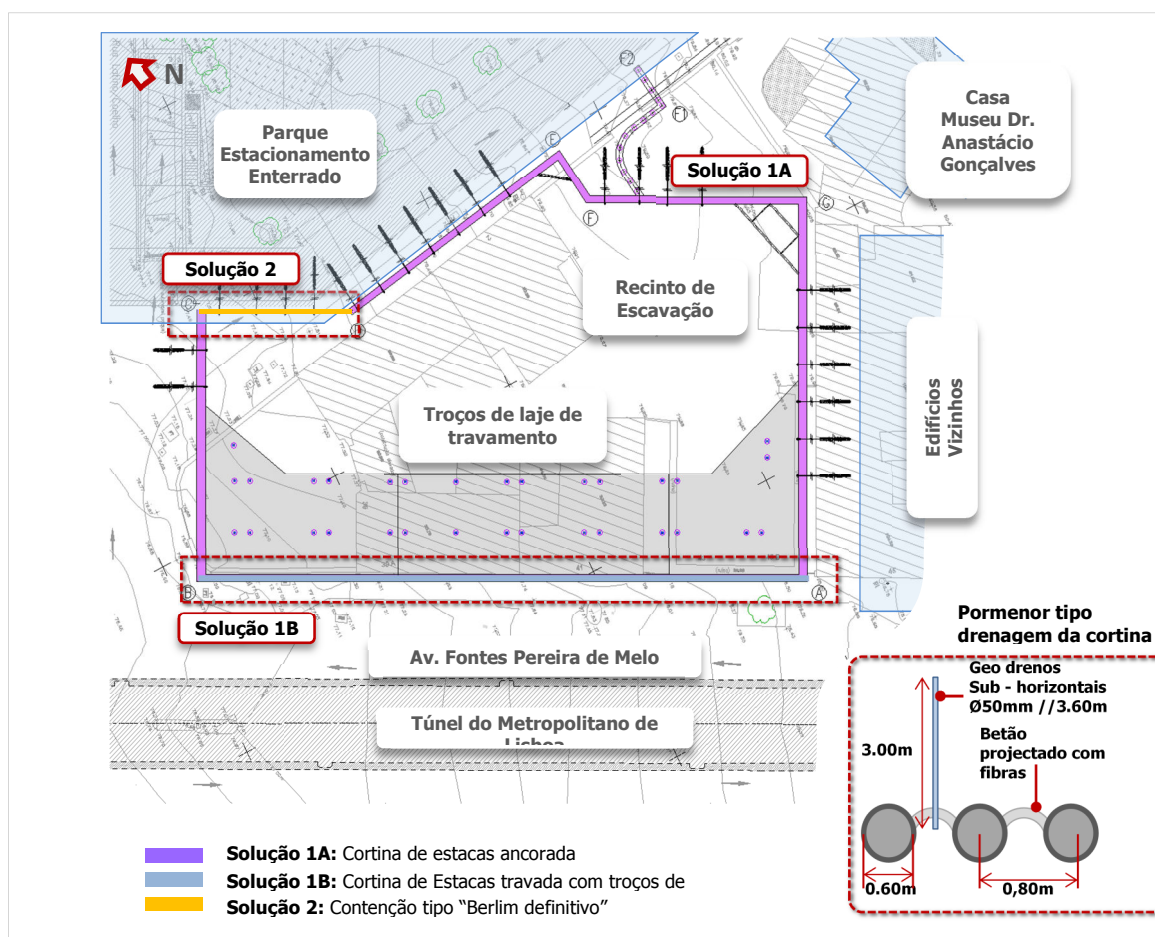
Planta da contenção e zonamento das soluções. Planta do pormenor da solução de drenagem da cortina.
